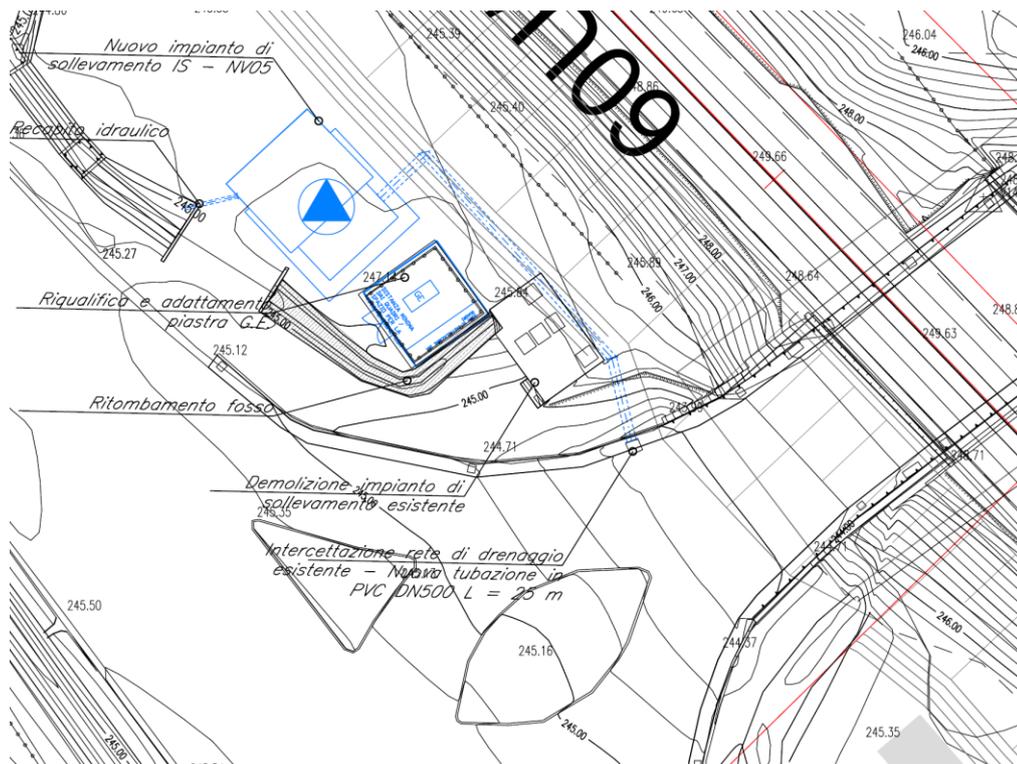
Inquadramento planimetrico impianto di sollevamento per viabilità al km 38+650
